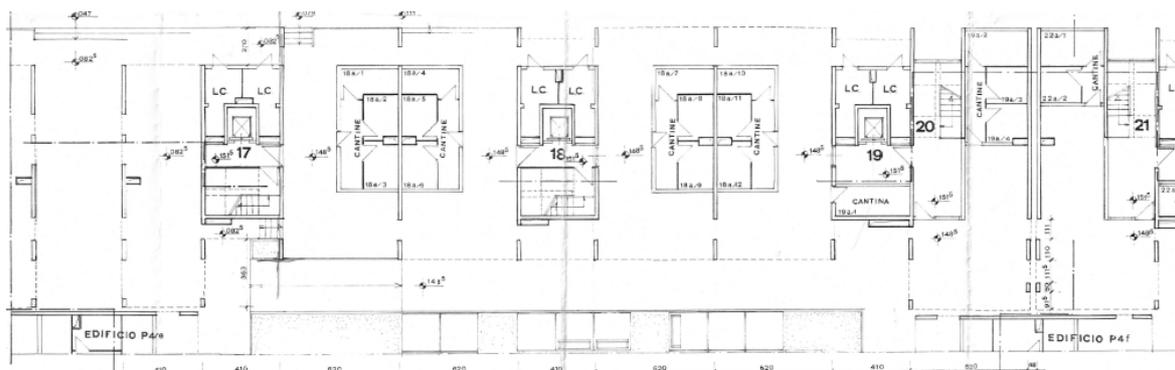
Pianta piano terra di una porzione del corpo P4a tra il corpo P4e e P4f
